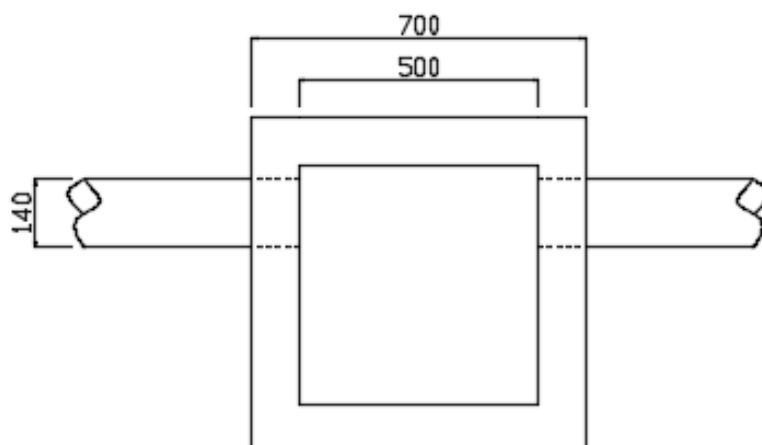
Arqueta de distribución vista en planta (Cotas mm)
